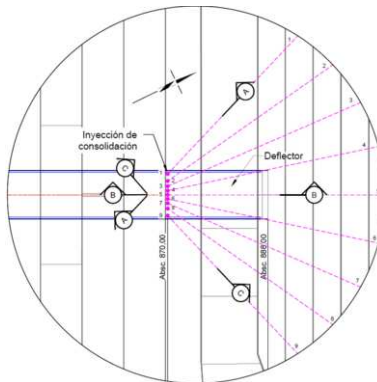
Planta de inyecciones desde la descarga intermedia al cuenco amortiguador.
